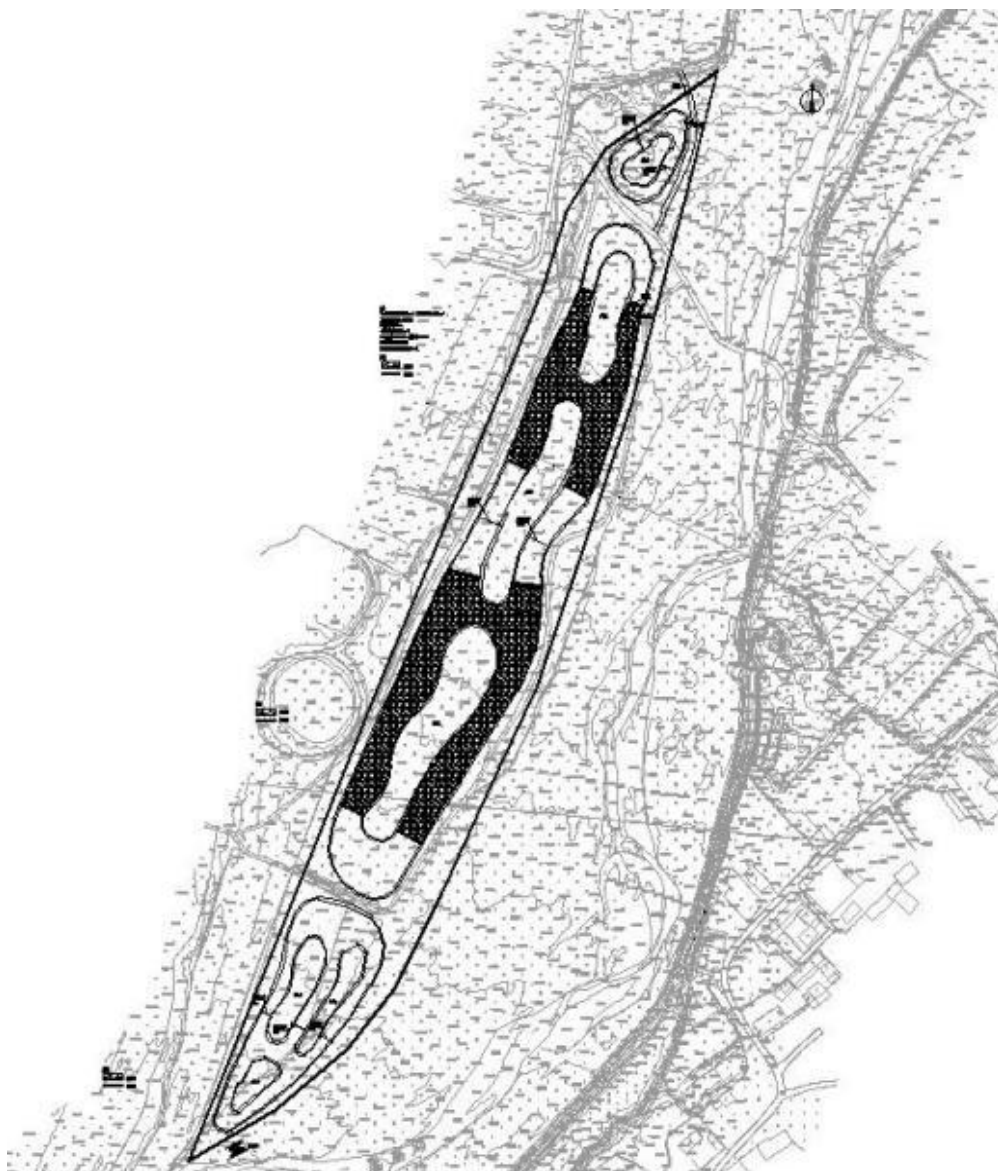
彭堡镇北侧水生态修复区平面布置图
